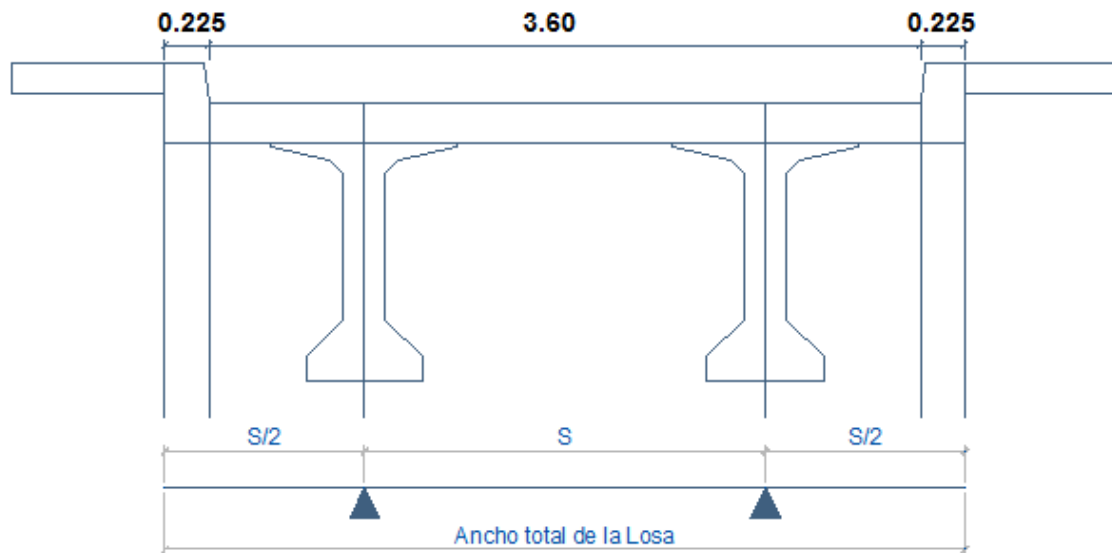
Separación de Vigas. Fuente: Elaboración propia.
